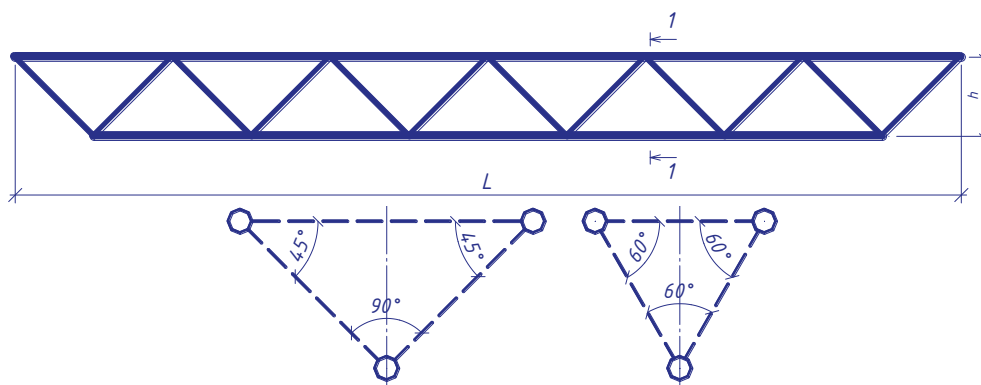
Трёхгранные фермы с различными углами сопряжения плоских ферм
